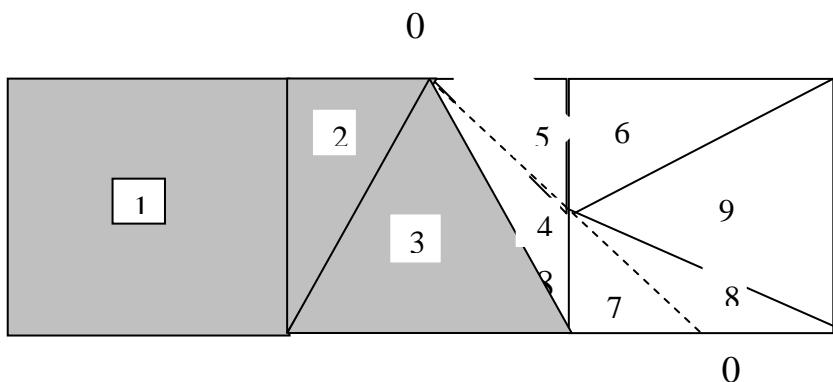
Картограмма земляных работ при проектировании горизонтальной площадки (фрагмент)
